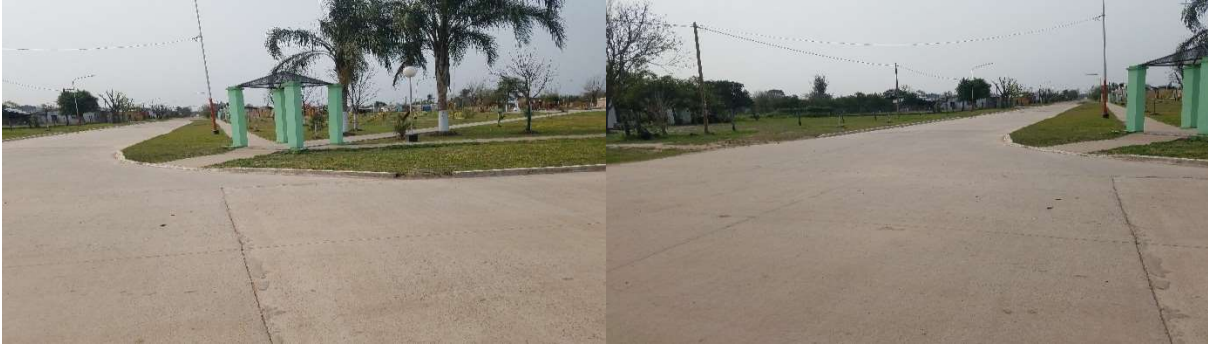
y 5: Calles pavimentadas alrededor de la plaza central
